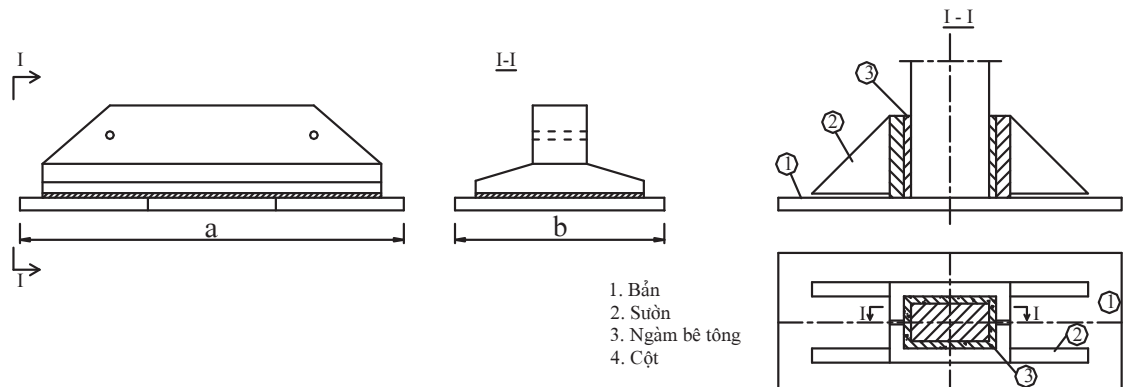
Cấu tạo một số móng đơn BTCT đổ tại chỗ
